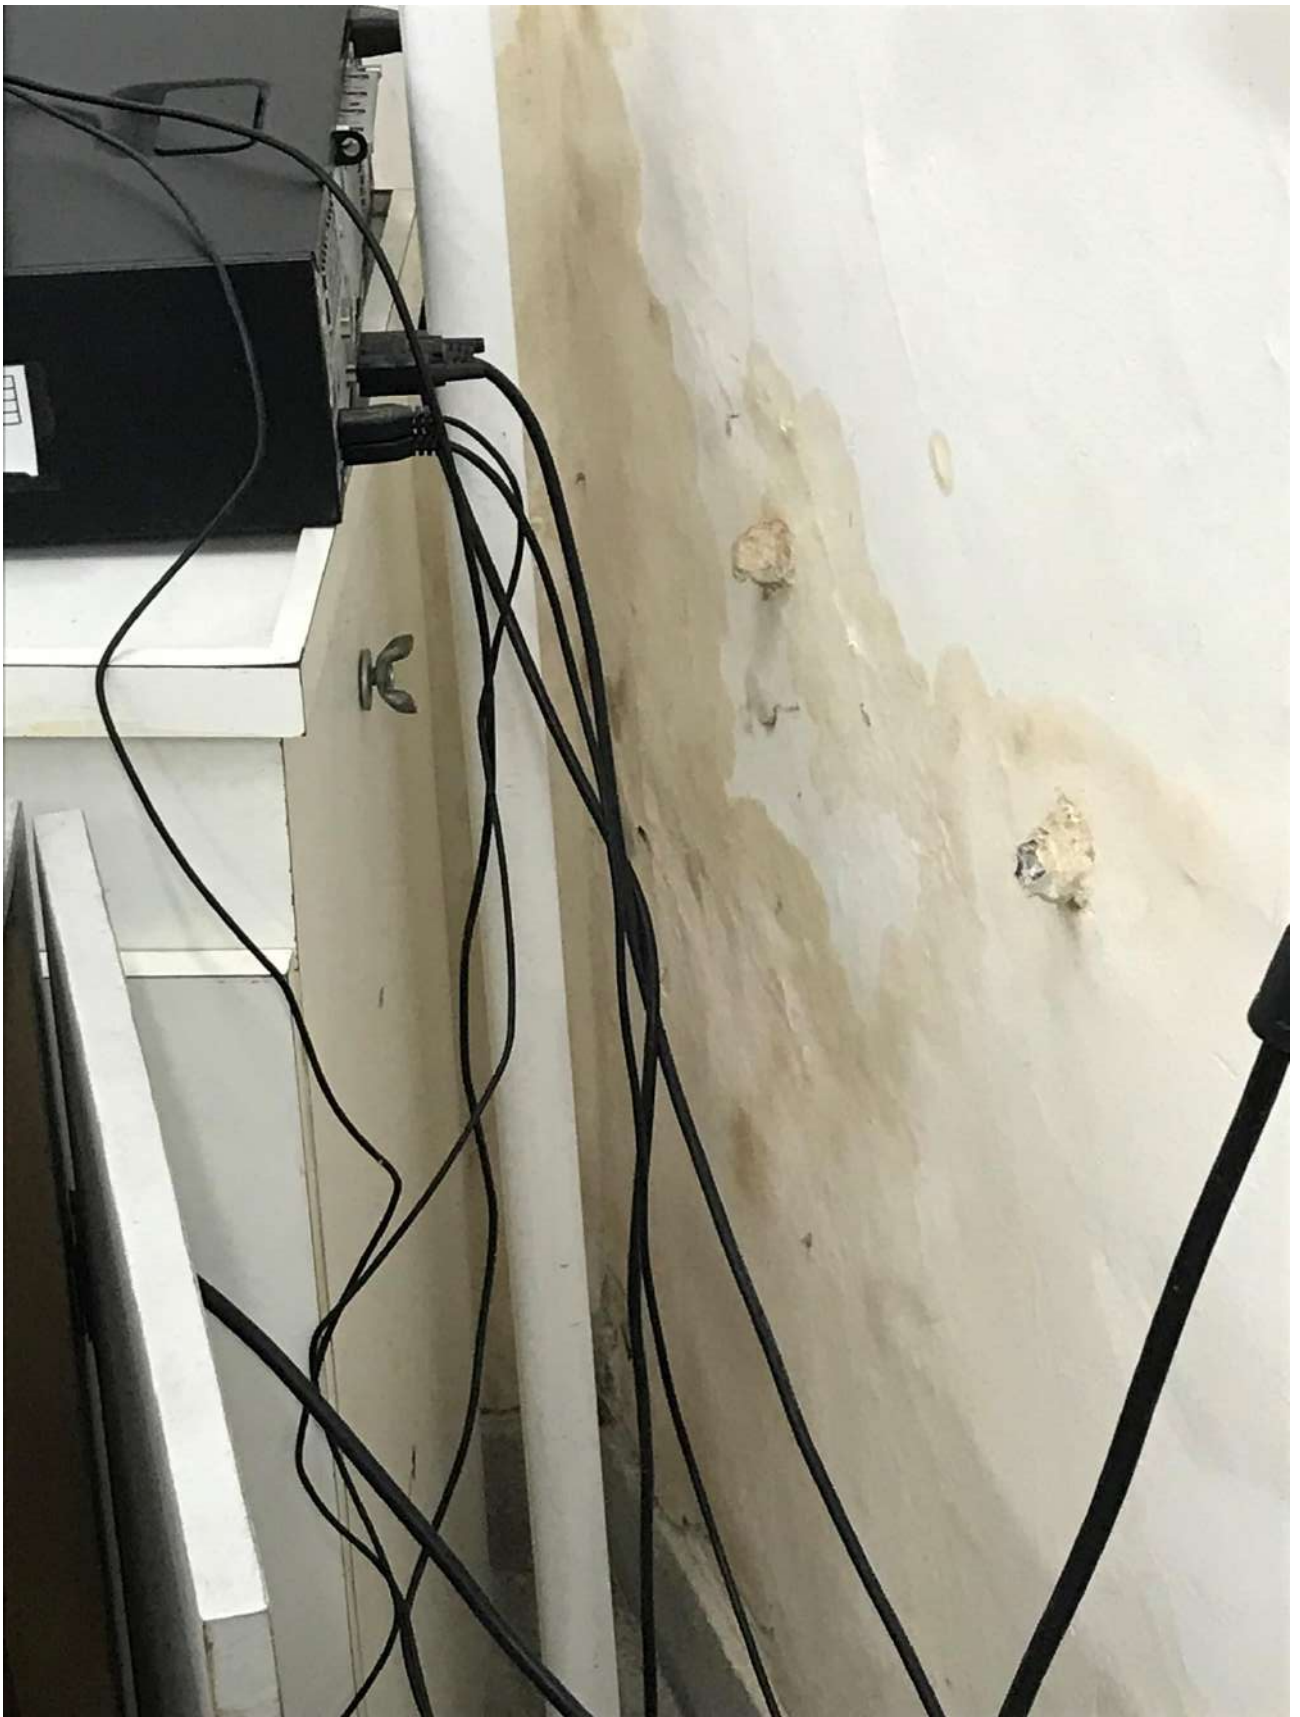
Infiltração na laje no Anfiteatro no 2º Pavimento próximo ao SVO (CCS)
